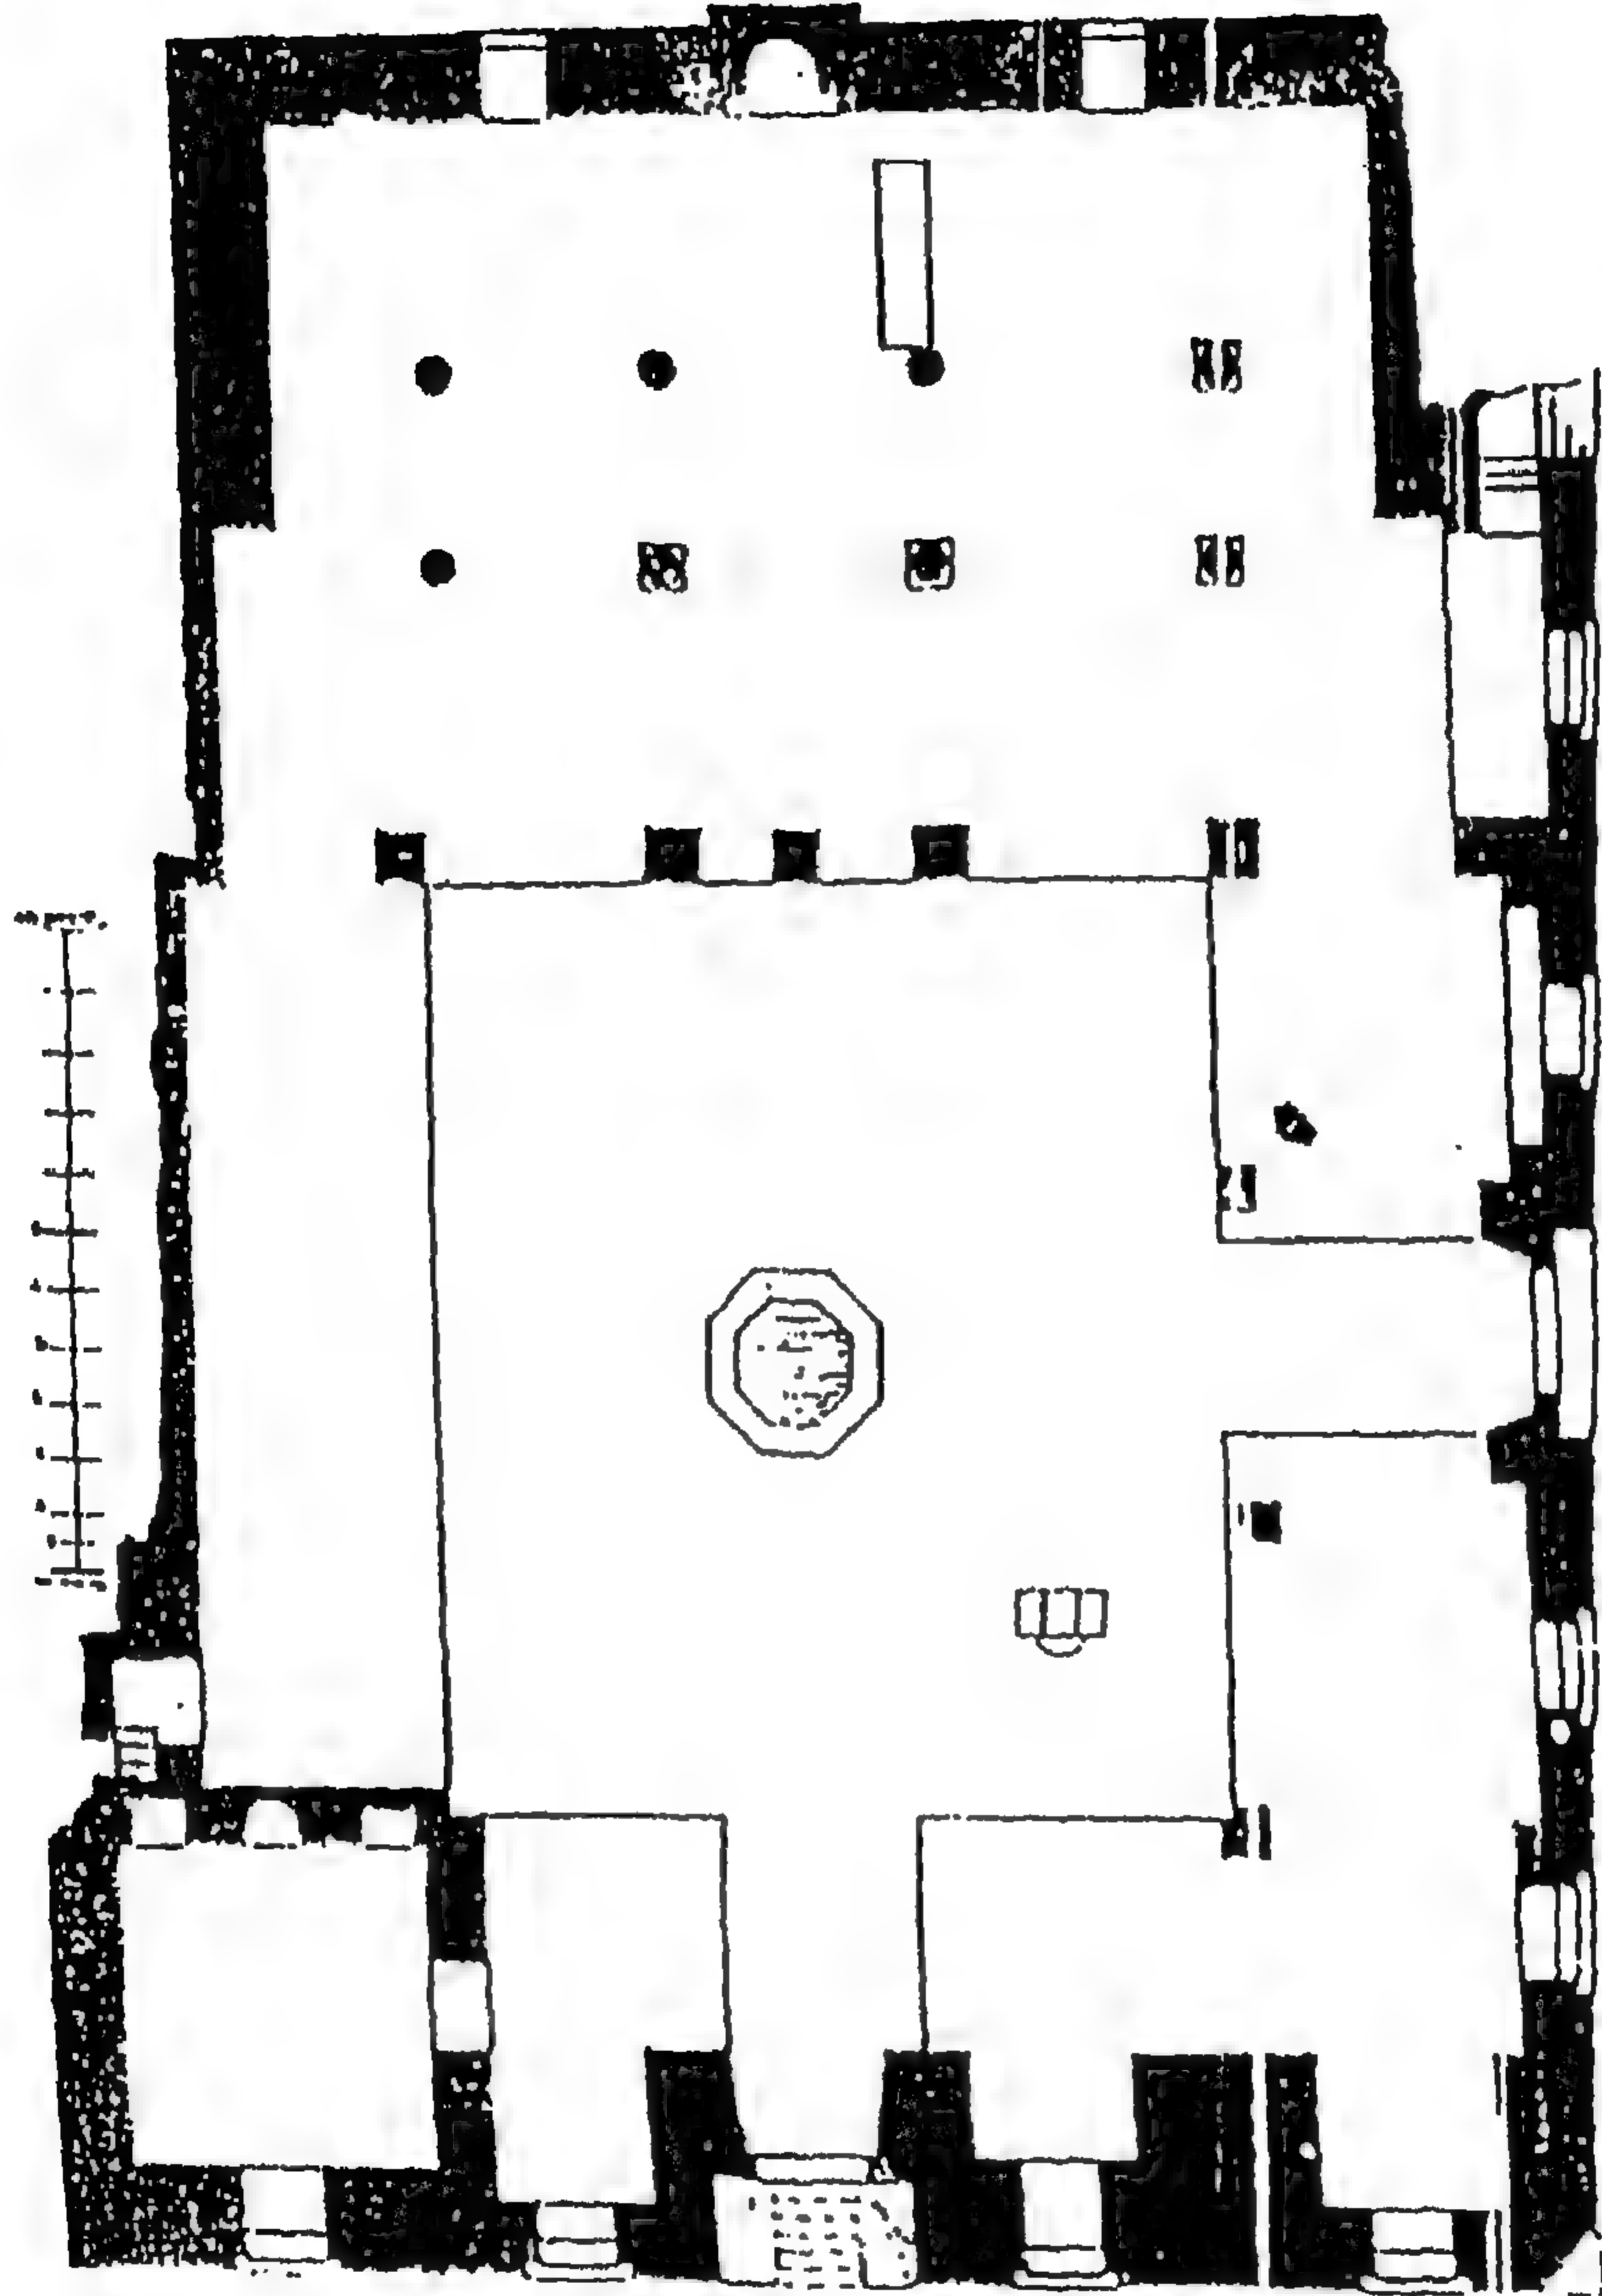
مسقط أفقي لجامع الصالح طلائع بالقاهرة
